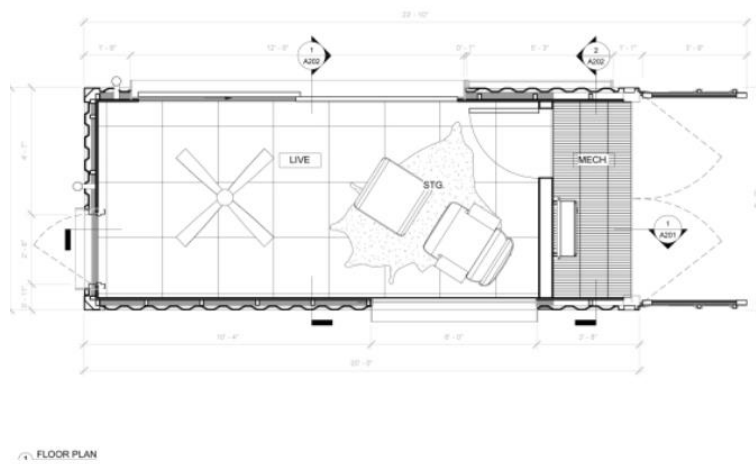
Vista en planta del Modelo NOS2. (New Old Stock, 2016).
